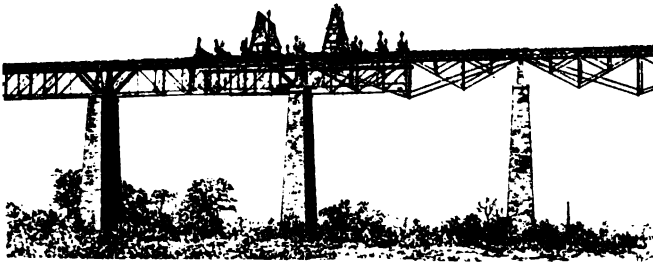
Changement des poutres du viaduc sur l'Appotomax
